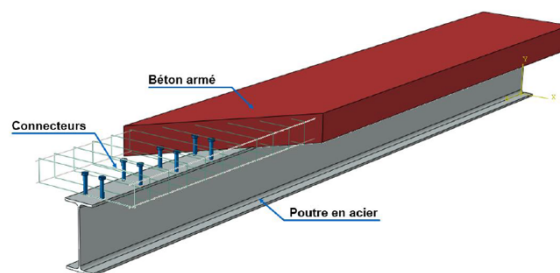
Poutre mixte acier-béton avec connecteurs soudés [2]
